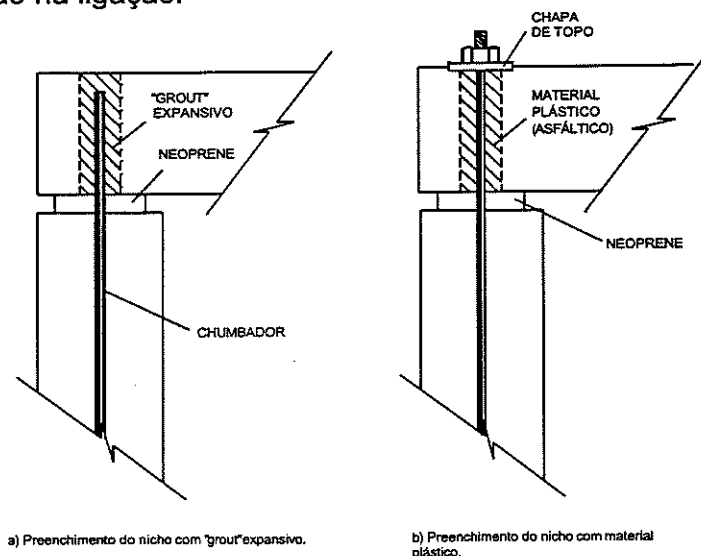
Detalhamentos para a ligação viga-pilar com almofada de elastômero e chumbador.
